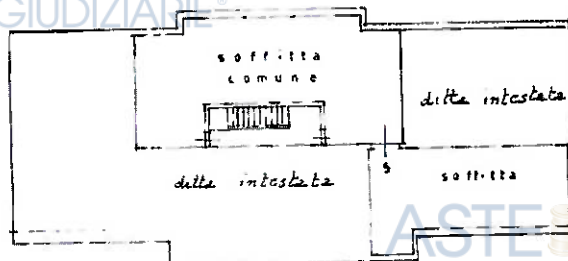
PLANIMETRIA CATASTALE - FOGLIO 63 PART. 536 SUB. 3 - SOFFITTA
